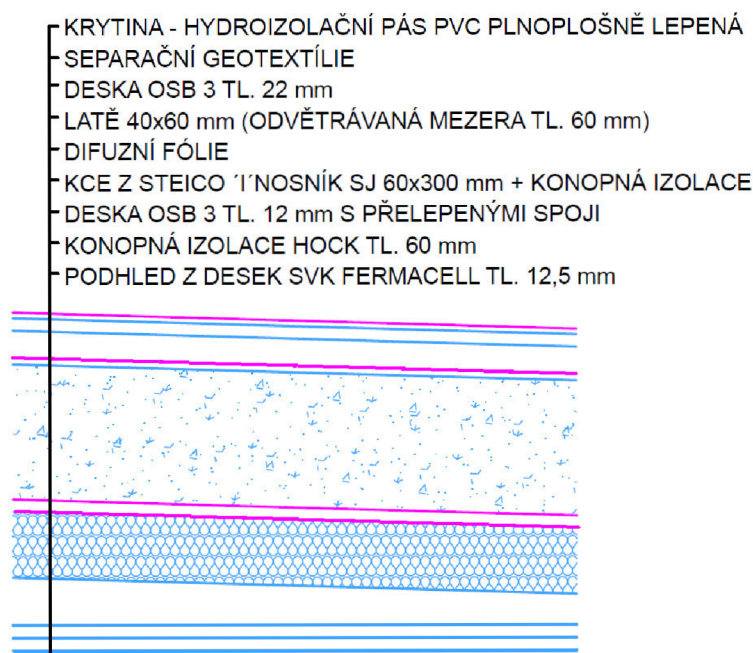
Detail obvodové konstrukce pro variantu III
